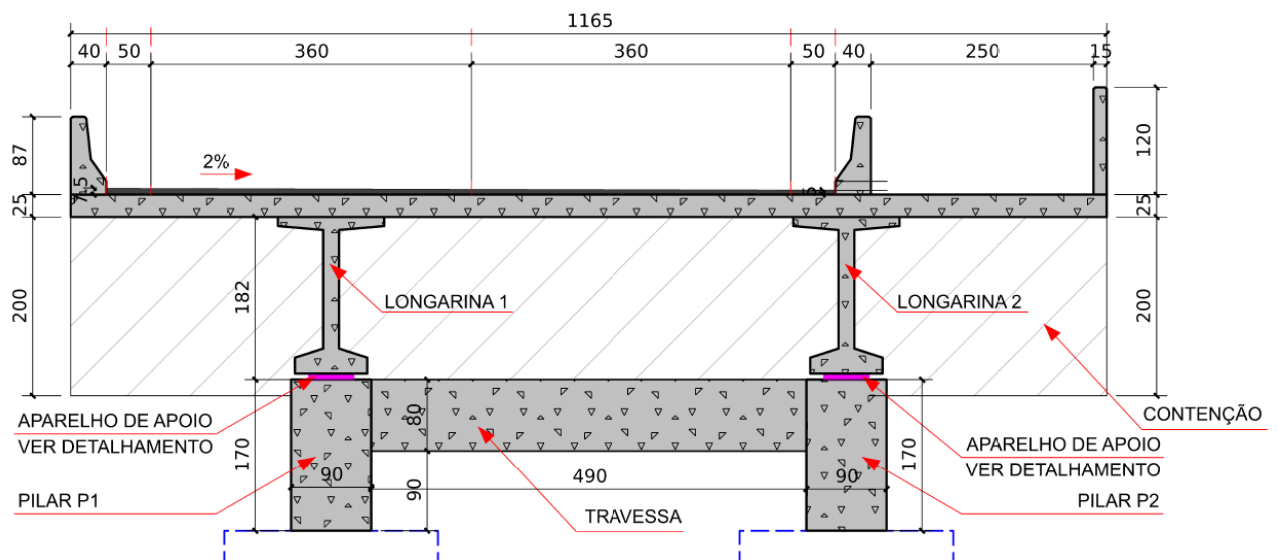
Seção Transversal Estrutural da Ponte na DF-140
